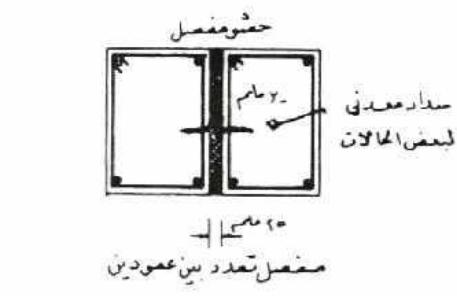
٤ ) مفصل تمدد مع وسادة
